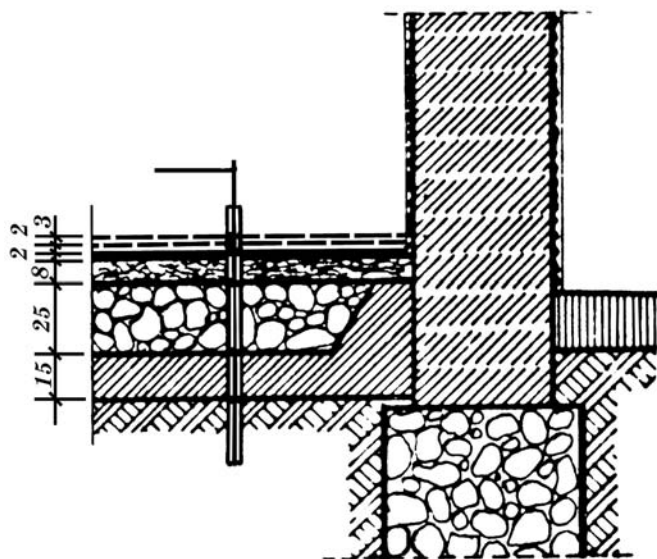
Конструктивный разрез стены здания со штырем-фиксатором в полу основания: 1 – переувлажненный грунт основания; 2 – железобетонная плита основания дома; 3 – гравийная насыпка; 4 – основание пола; 5 – настил пола; 6 – стена дома; 7 – отмосвка; 8 – бутобетонный фундамент; 9 – труба-фиксатор (ее размеры по месту), но не более 65 см длины.
